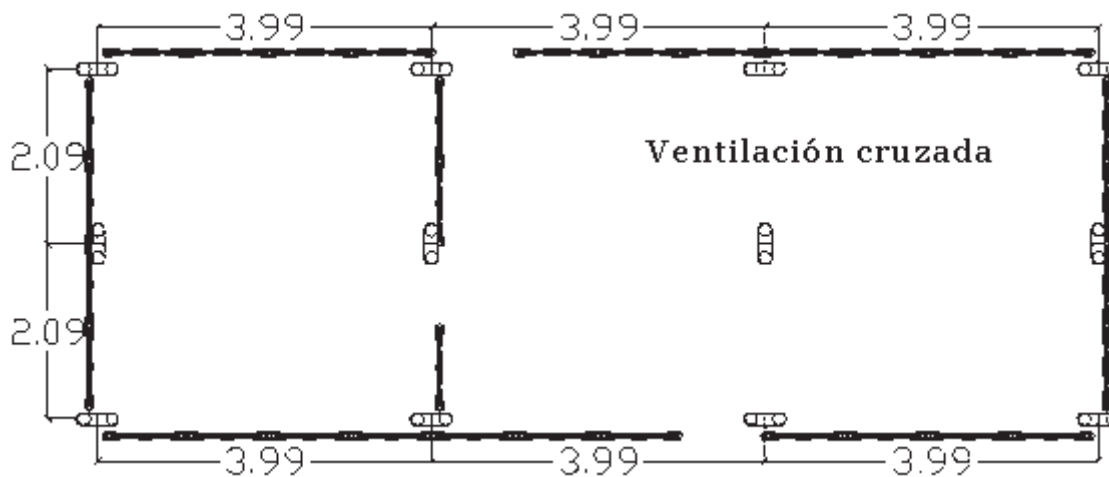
Planta de una vivienda, en la que se muestra la ventilación cruzada provocada por la disposición de las puertas.
